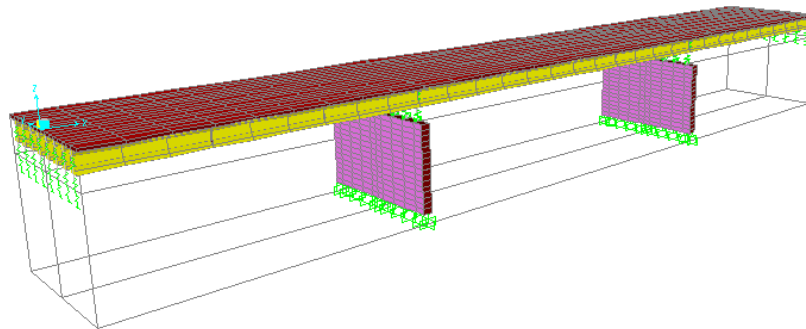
Modelo analítico del Puente Copándaro II con pilas tipo muro modelado utilizando la herramienta “Bridge Wizard”, “Extrude View” (SAP2000).
